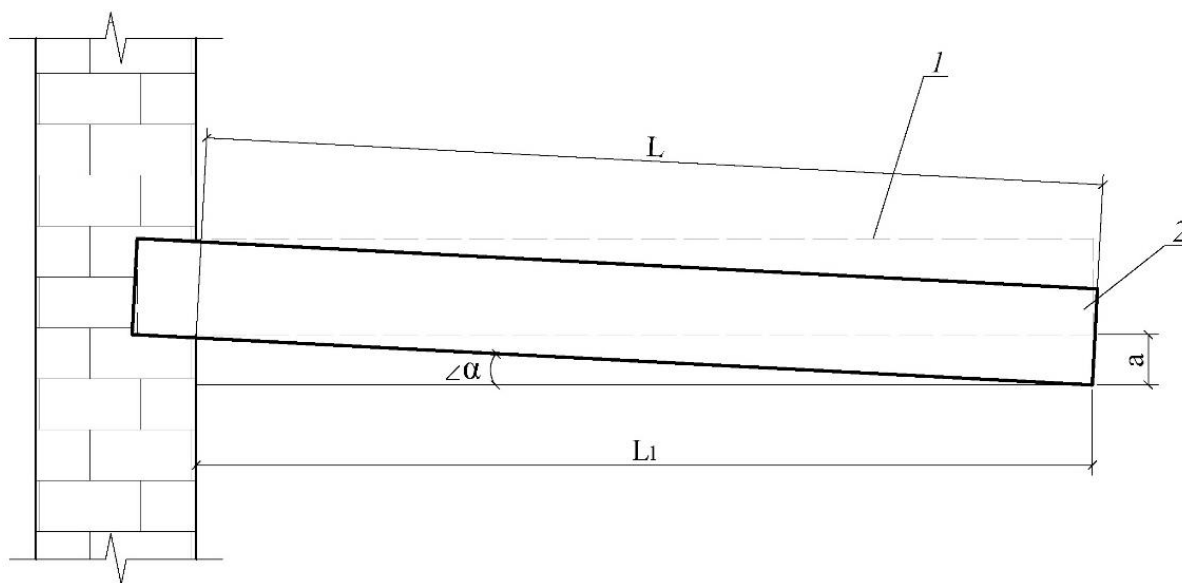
Принципиальная схема уклона железобетонной балконной плиты, козырька входа: 1 – нормальное положение; 2 – плита с уклоном; L – длина плиты, см; L_1 – вылет плиты (проекция длины L), см; a – разница высотных отметок в месте заделки плиты и на конце плиты, см; α – угол уклона, °.
